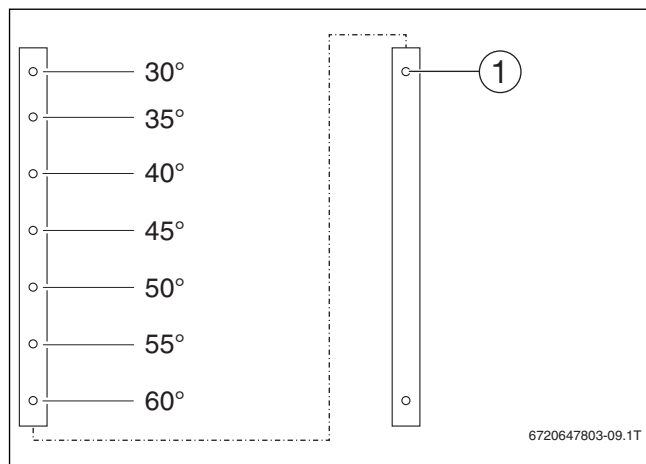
Монтаж телескопічної шини — вертикальний тип колектора
